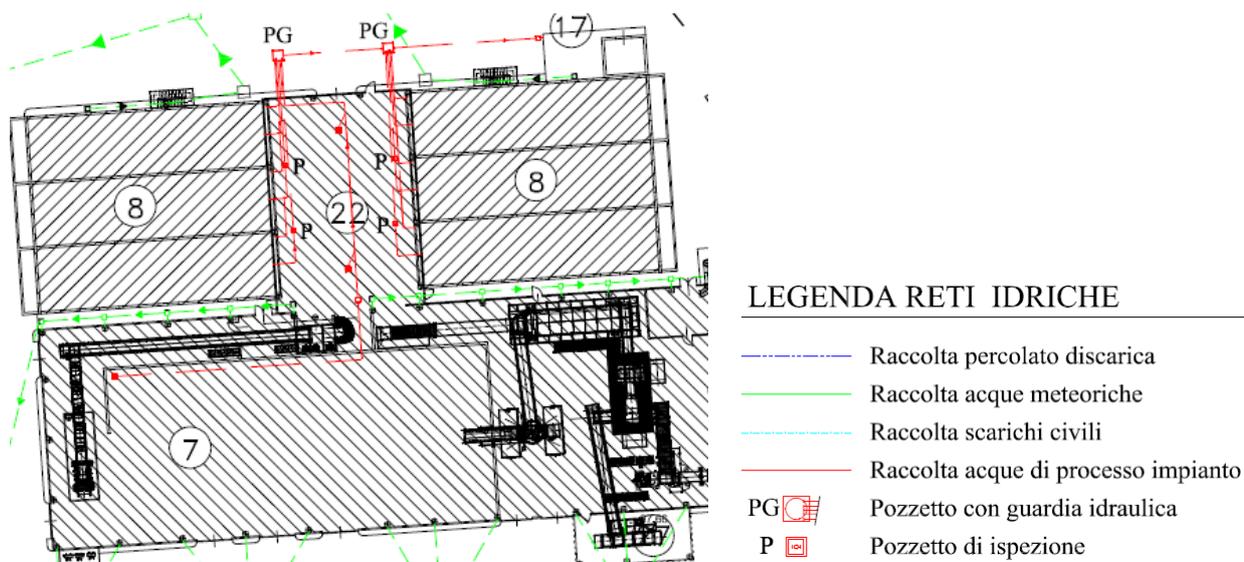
Stralcio da Allegato 6 – Planimetria reti e scarichi – Eluati di processo da trattamento rifiuti
